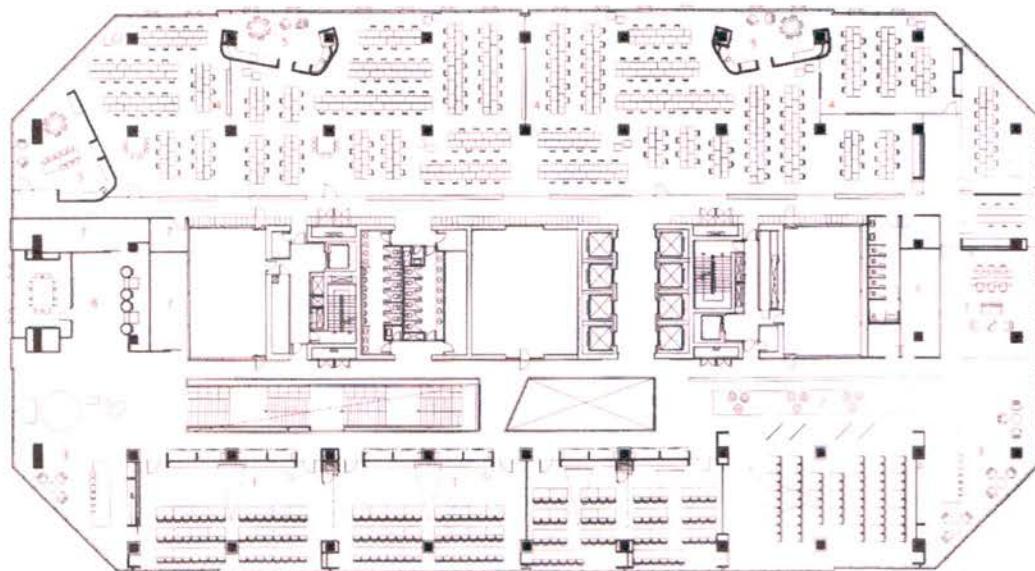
แสดงบริเวณ 1th Floor Plan
